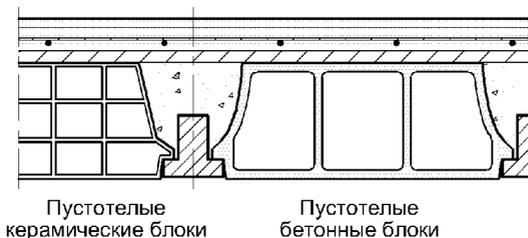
Конструктивное решение плиты перекрытия с «независимой» набетонкой
